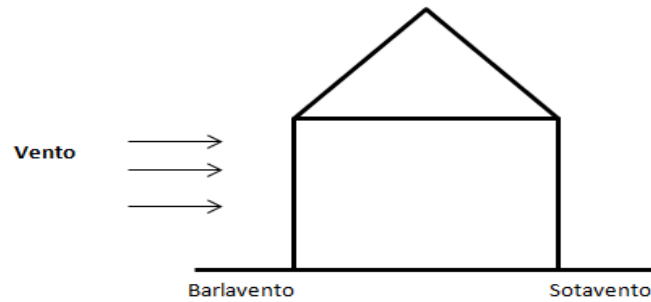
Barlavento e sotavento segundo a direção do vento.
